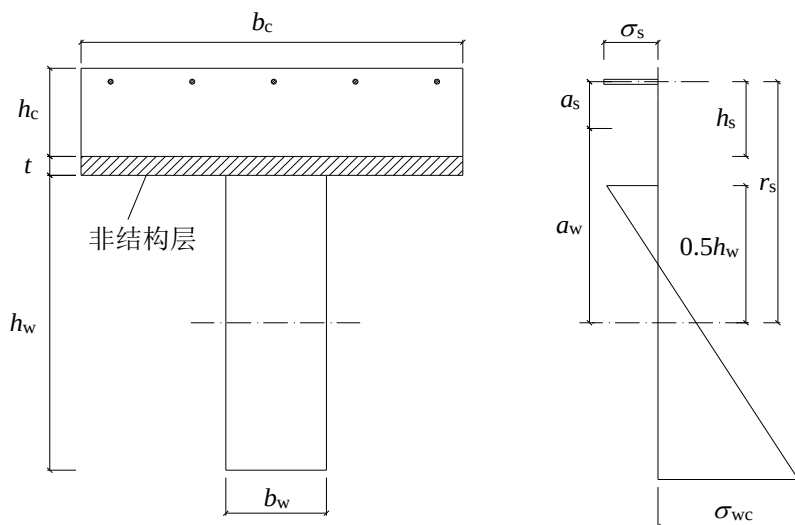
负弯矩作用下木-混凝土组合梁横截面和应力示意
